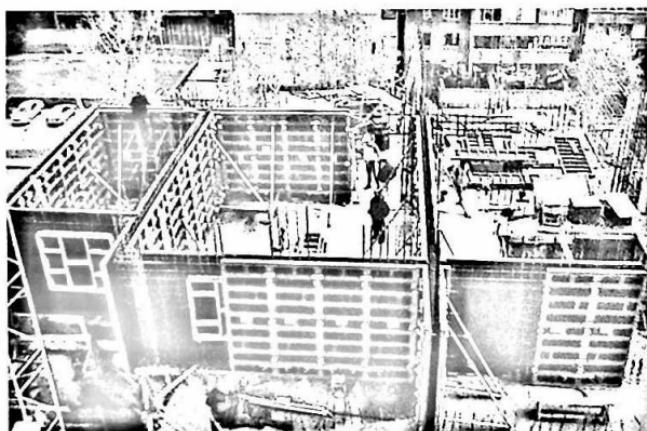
Монтаж крупнощитовой стеновой опалубки
